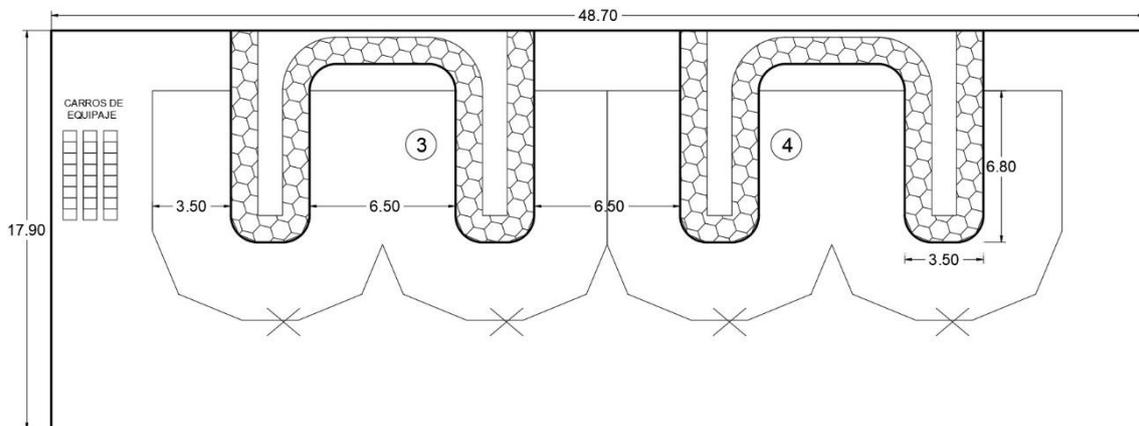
Vista en planta. Recolección de equipaje (nacional).
